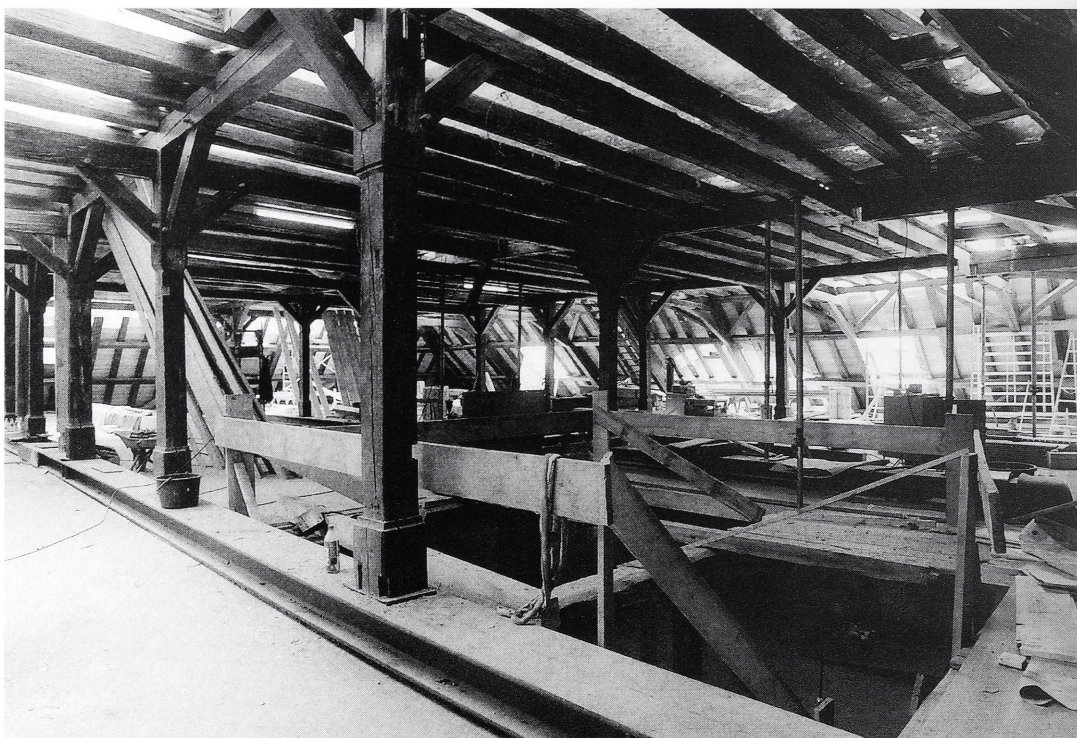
Überlingen, Greth, Blick in das barocke Dachwerk.
